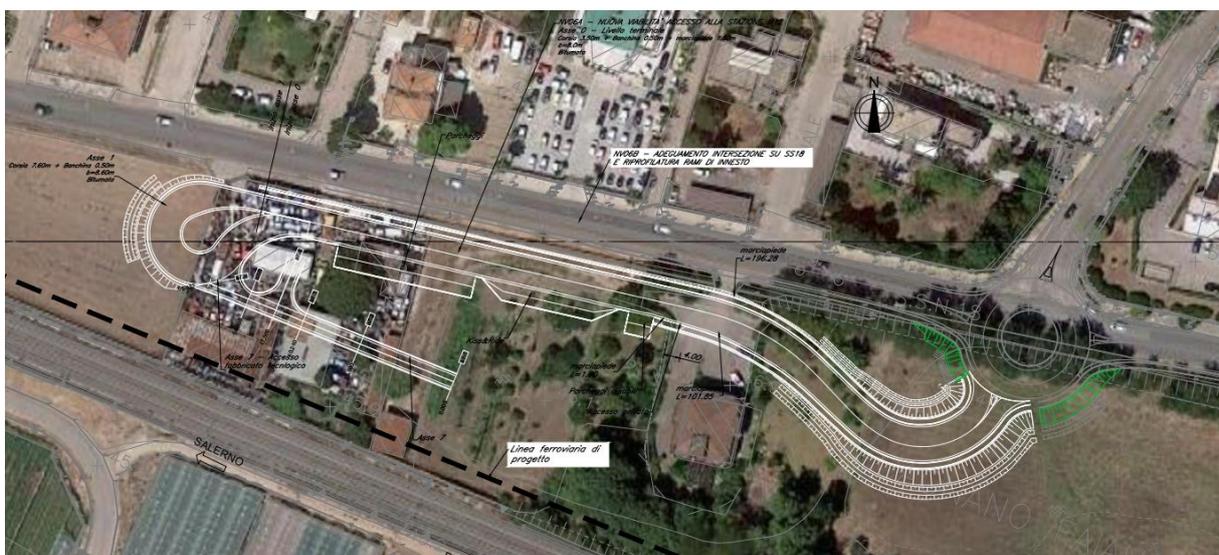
Stralcio planimetrico – NV06A\_Nuova viabilità di accesso alla Stazione M12
